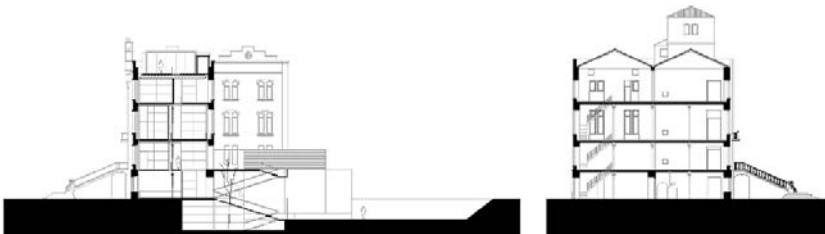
Secciones transversales. Edificio Reutilizado/Edificio Original.
